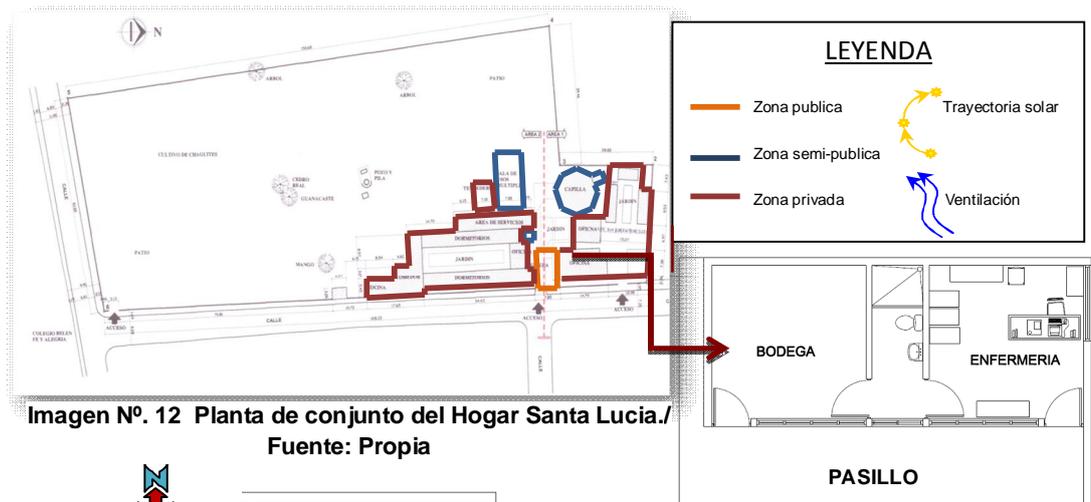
Planta de conjunto del Hogar Santa Lucía./
